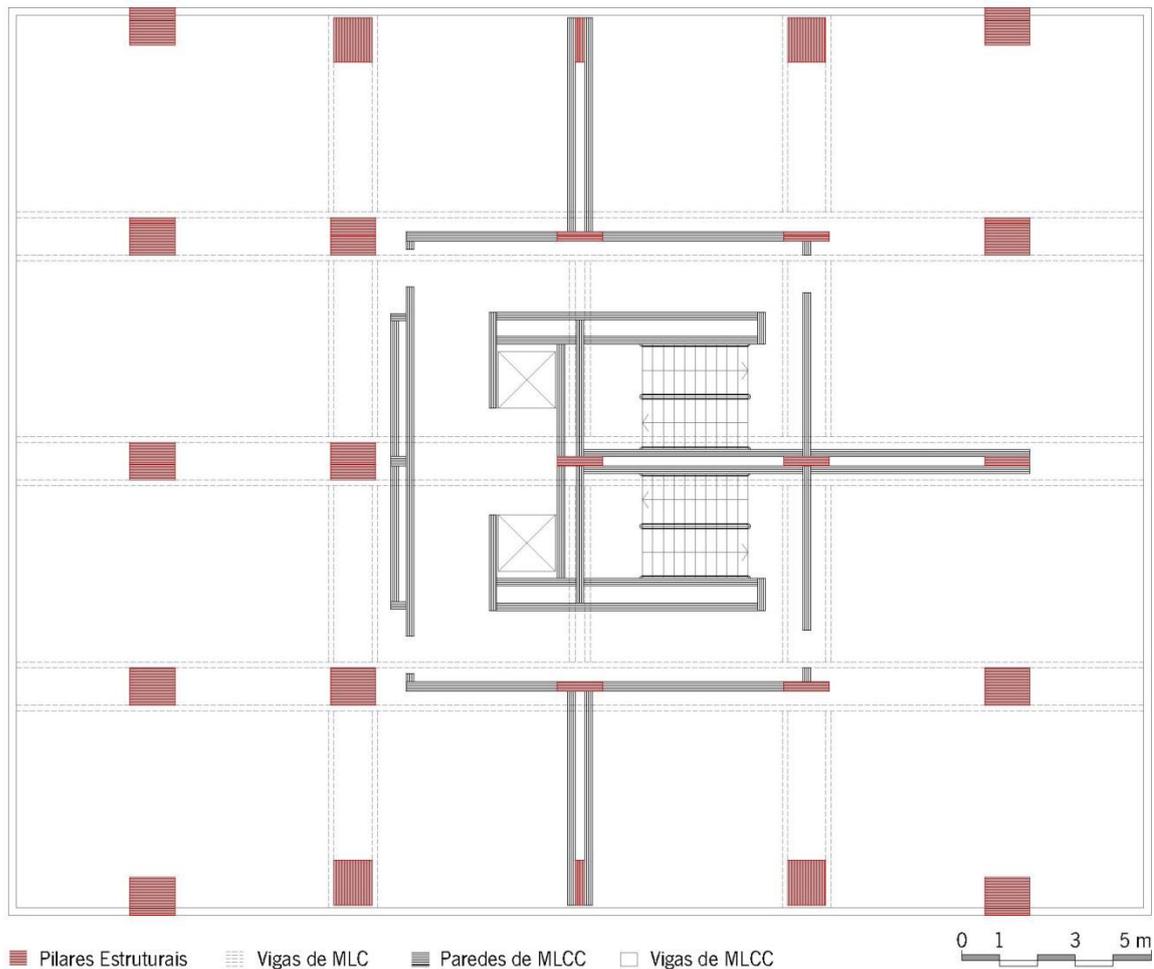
Planta de Piso-tipo com Elementos Estruturais do Tipo MLCC 1000 mm ²⁷
